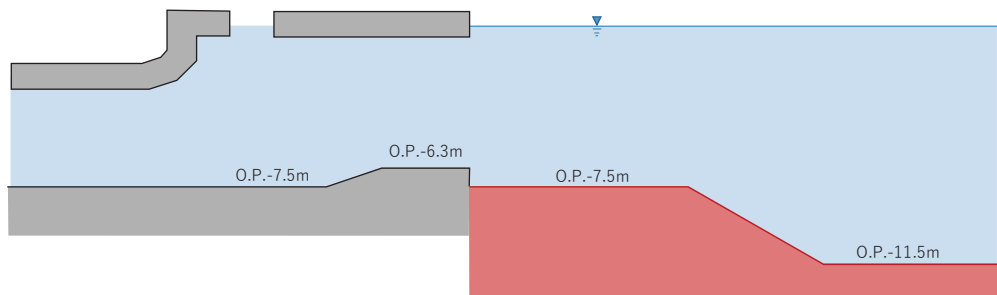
貯留堰前面の海域（港湾内）を含めた断面のイメージ図
